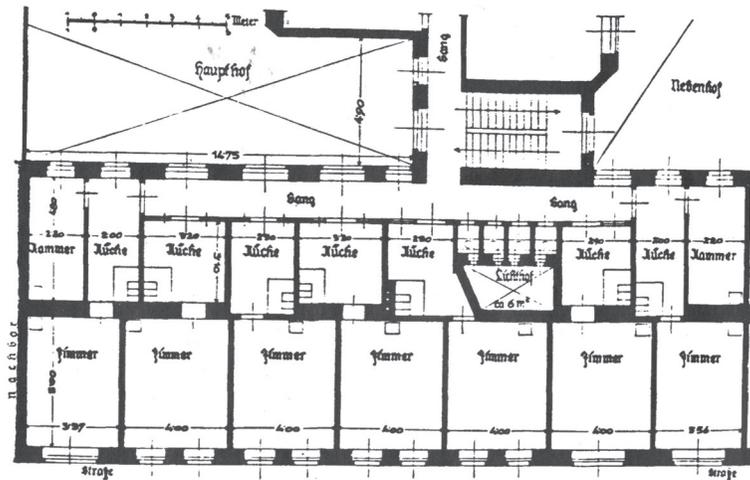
Typischer Grundriss eines „Bassenahauses“
